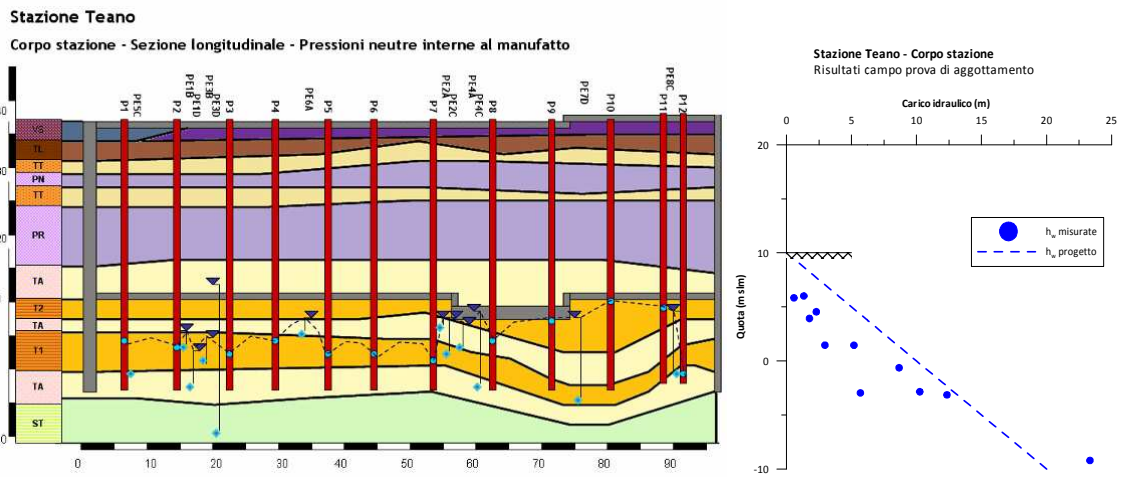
Stazione Teano: corpo stazione: profilo delle pressioni neutre al di sotto del fondo scavo – Sezione longitudinale
